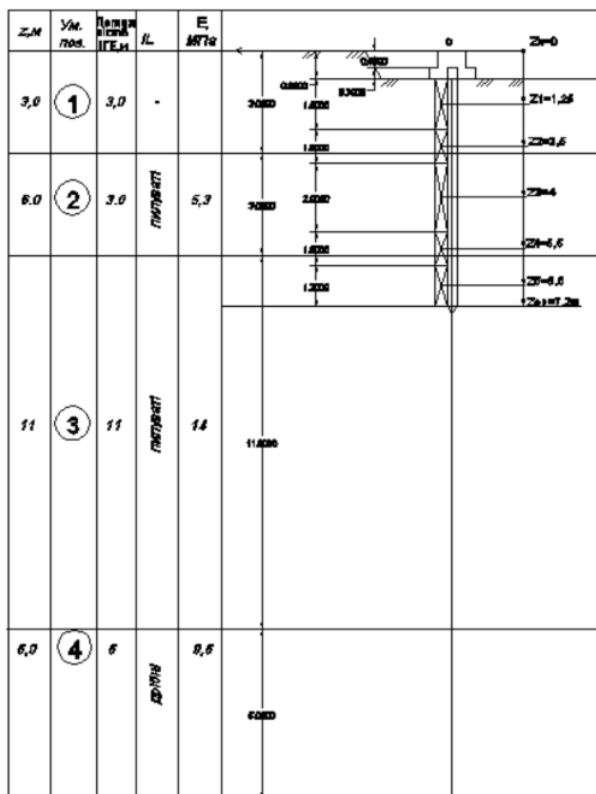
Розрахункова схема для визначення осадки пального фундаменту СФ-1.
